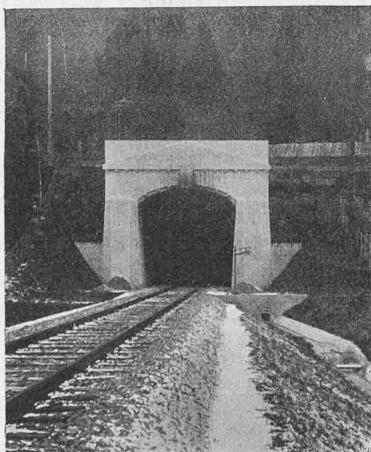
Eisenbeton-Portal des Schlossberg-Tunnels in Tübingen.
